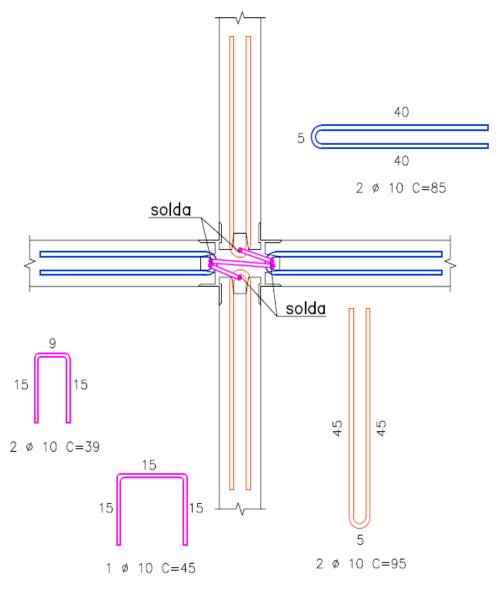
Detalhe dos pontos de solda e das armaduras de ligação.
